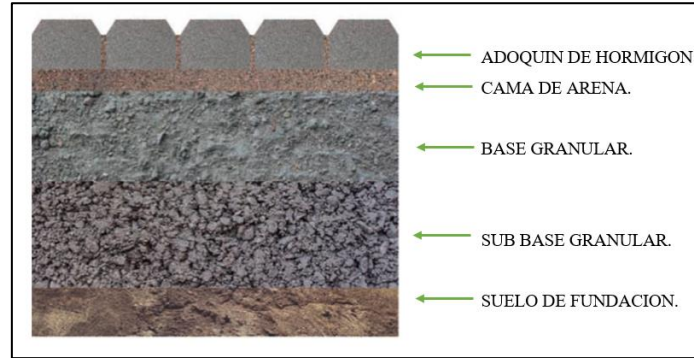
Esquema del paquete estructural para pavimento con adoquines
